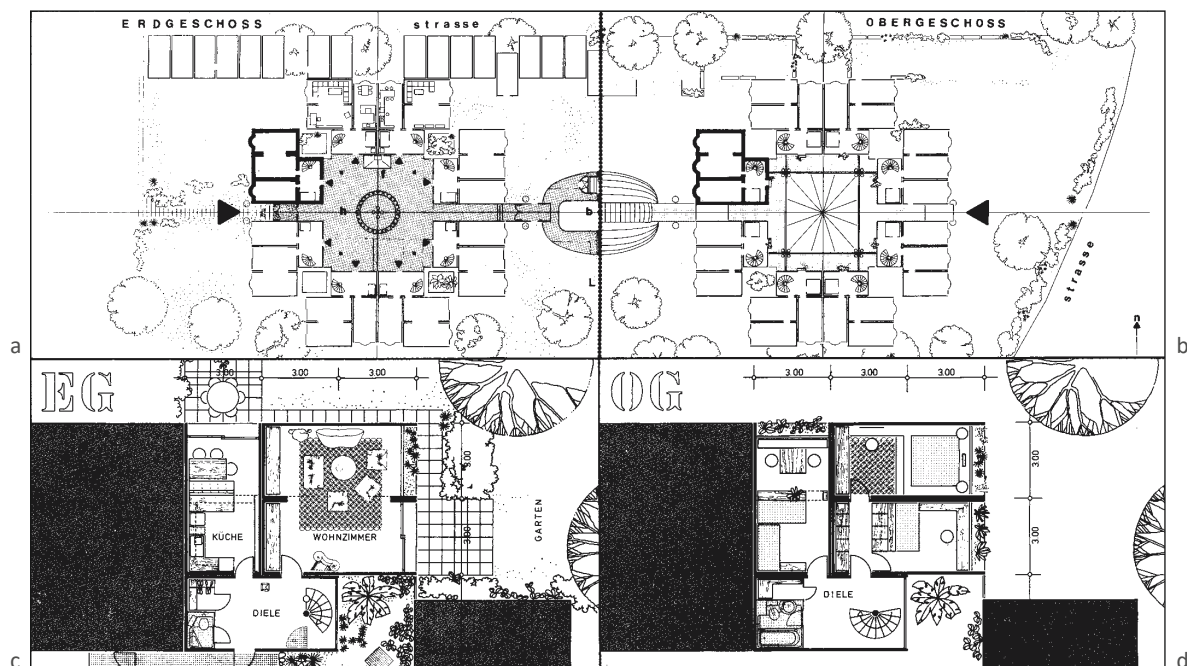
a Erdgeschoß-Grundriss des westlichen Atriumhauses der ersten Wohnanlage in Leonding, 1974
